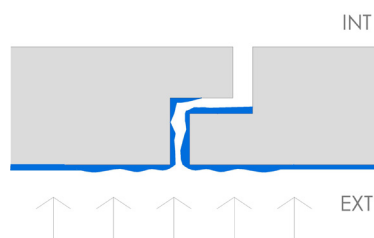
Esquema de infiltración de agua por tensión superficial en junta rebajada de 5 mm de espesor. Vista en planta.
